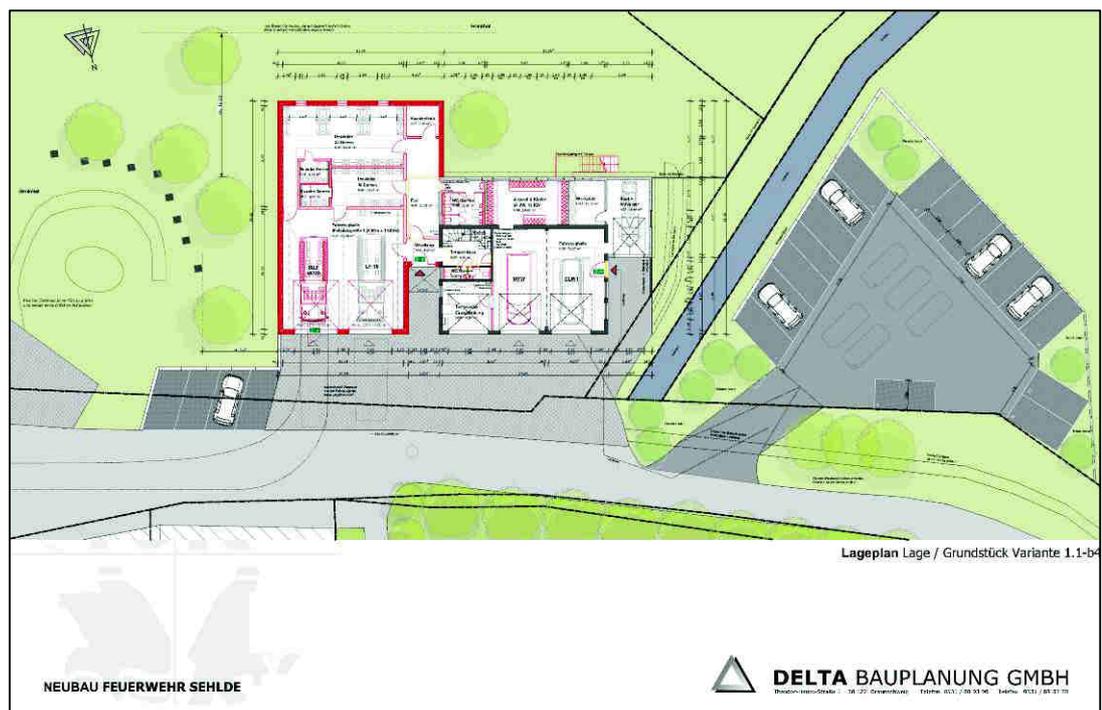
Planentwurf Büro Delta Bauplanung GmbH, Braunschweig
